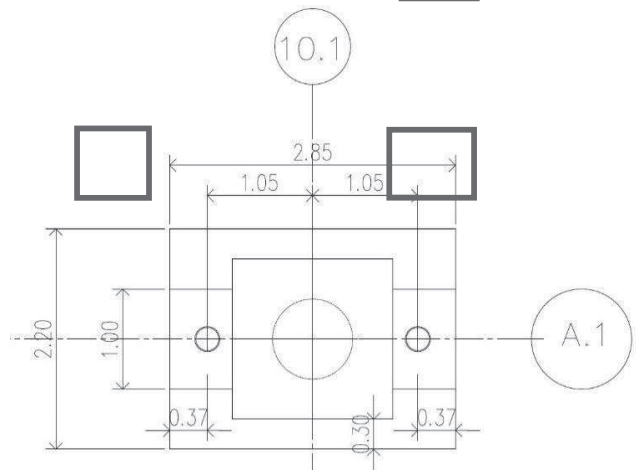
Foundation Plan ของอาคารกรณีศึกษา
